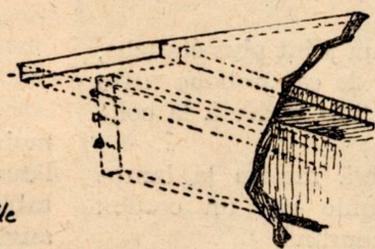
Fixation d'une traverse longitudinale et verticale aux flancs.
